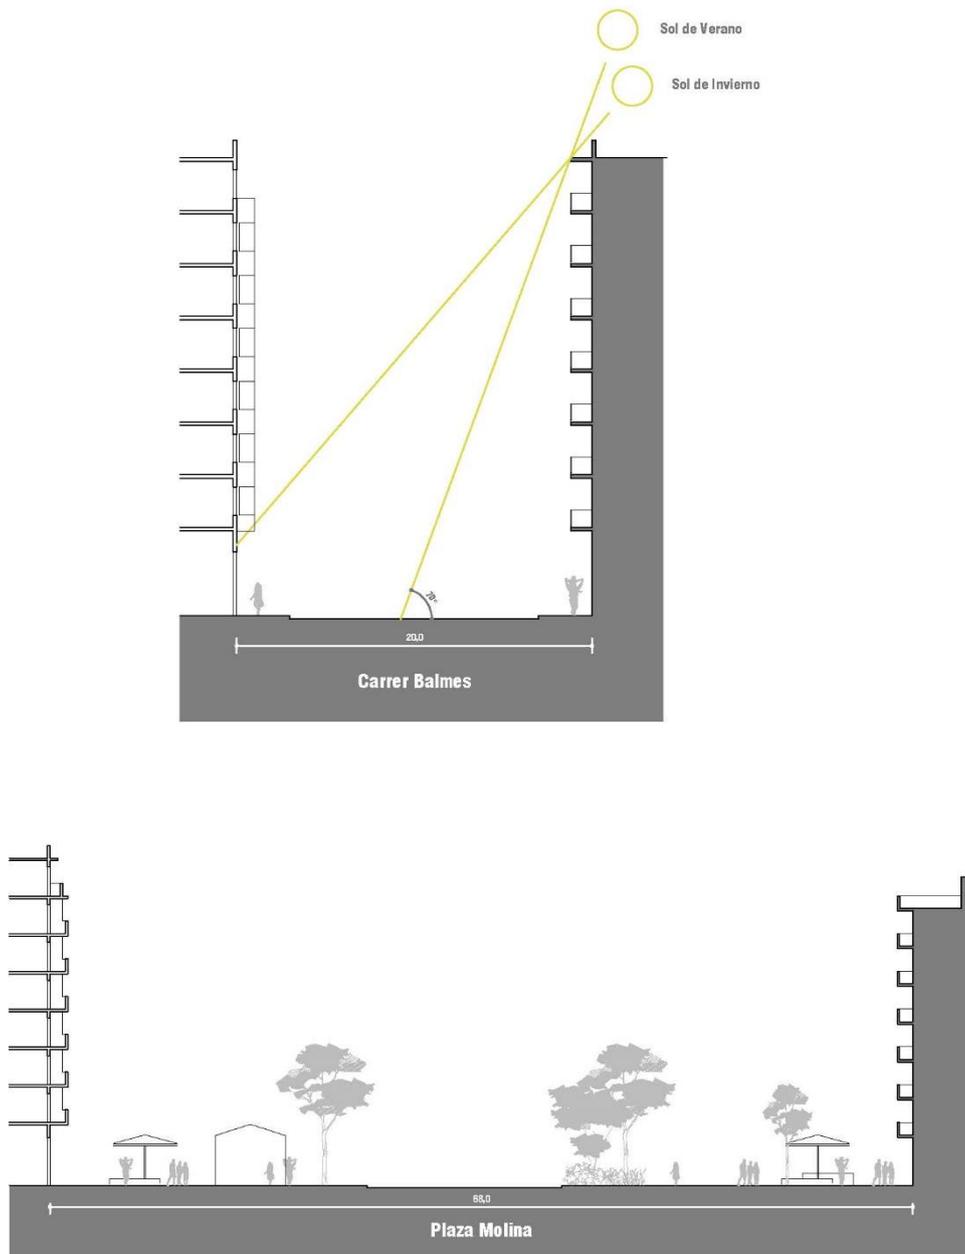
Sección transversal de las calles laterales del edificio. La distancia entre las edificaciones garantiza un buen asoleamiento de las fachadas. Fuente elaboración propia.
